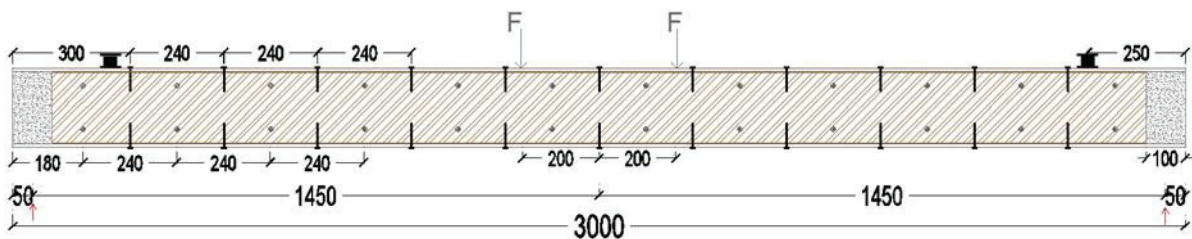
Vue longitudinale des poutres hybrides avec vis additionnelles
